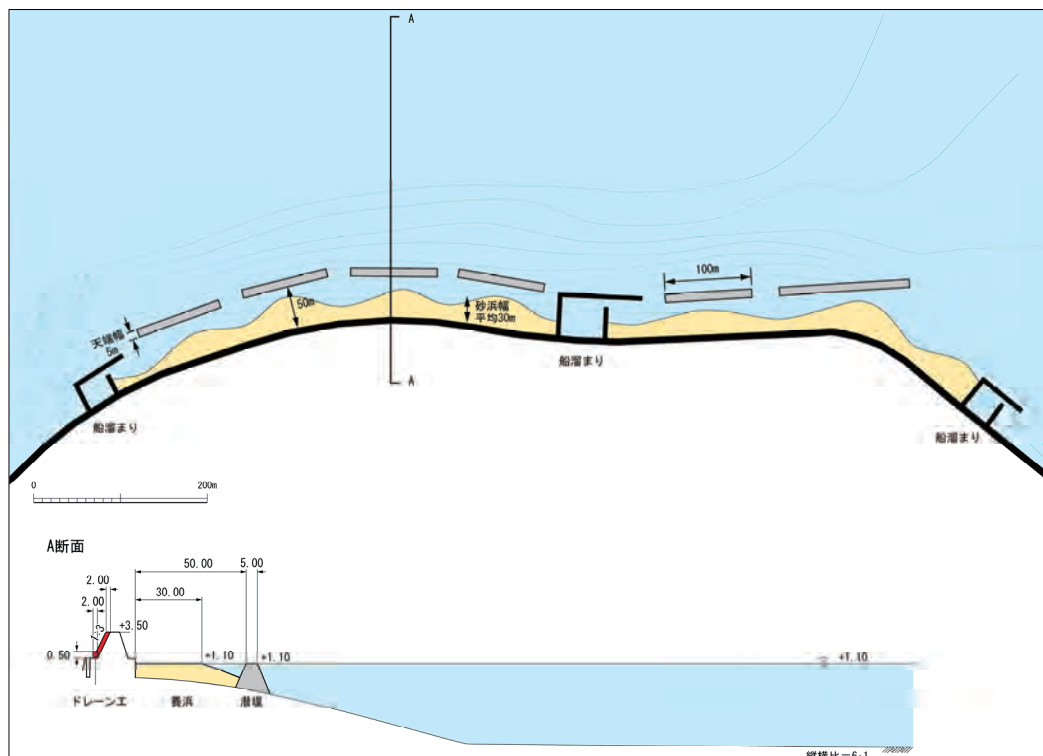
・9 B-2ゾーン 湖岸整備の平面配置および断面図案
